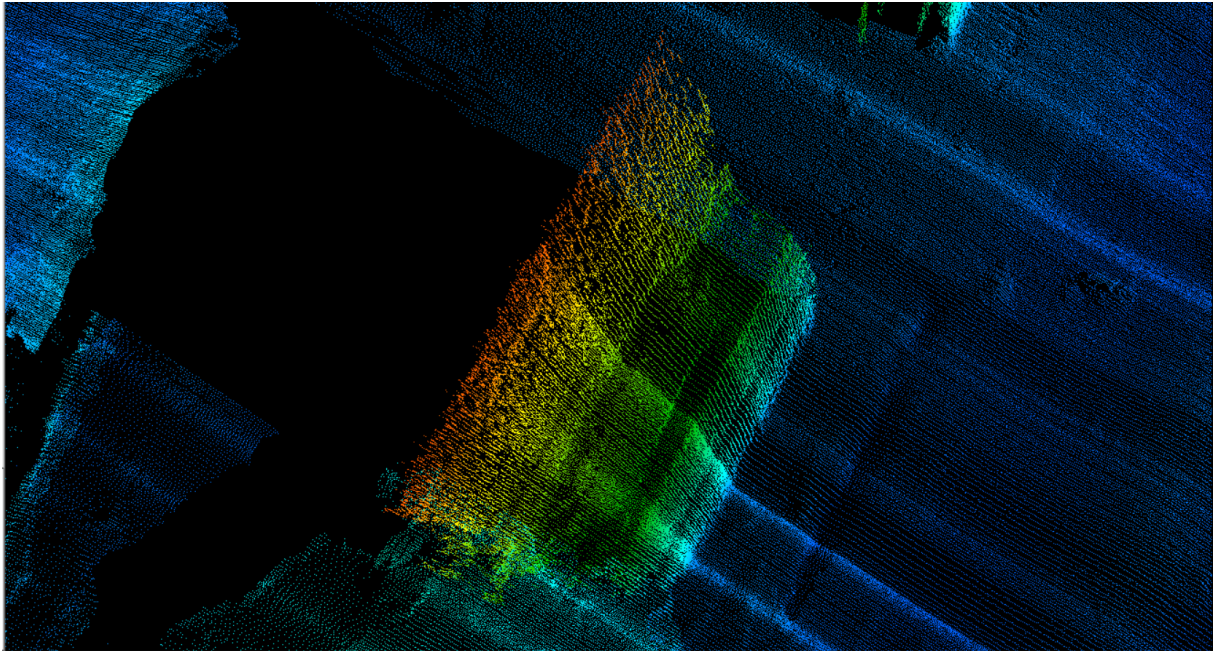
Vista superior paramento frontal y cimentación de pila P5.
